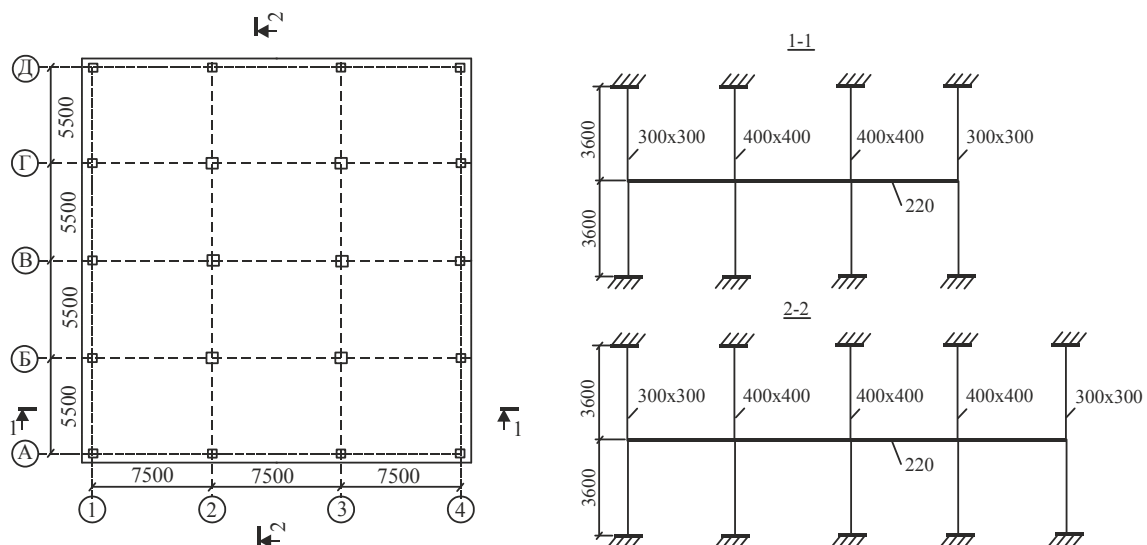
Схема фрагмента каркаса с перекрытием и прилегающими колоннами
